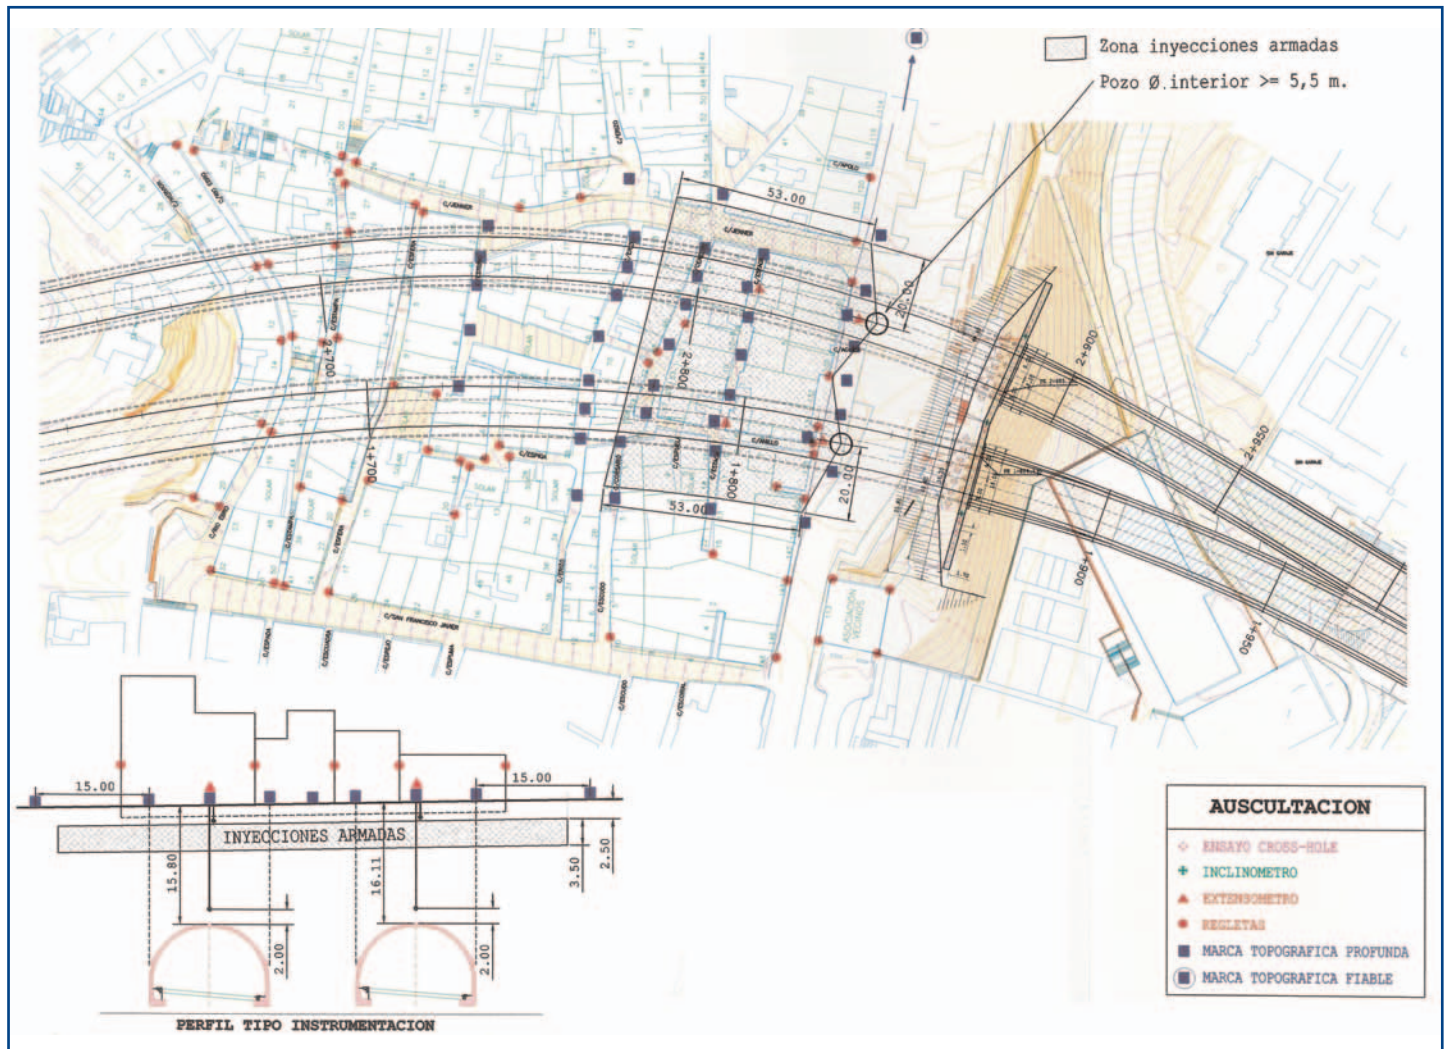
Planta y sección transversal con la posición relativa de túneles y edificios.
